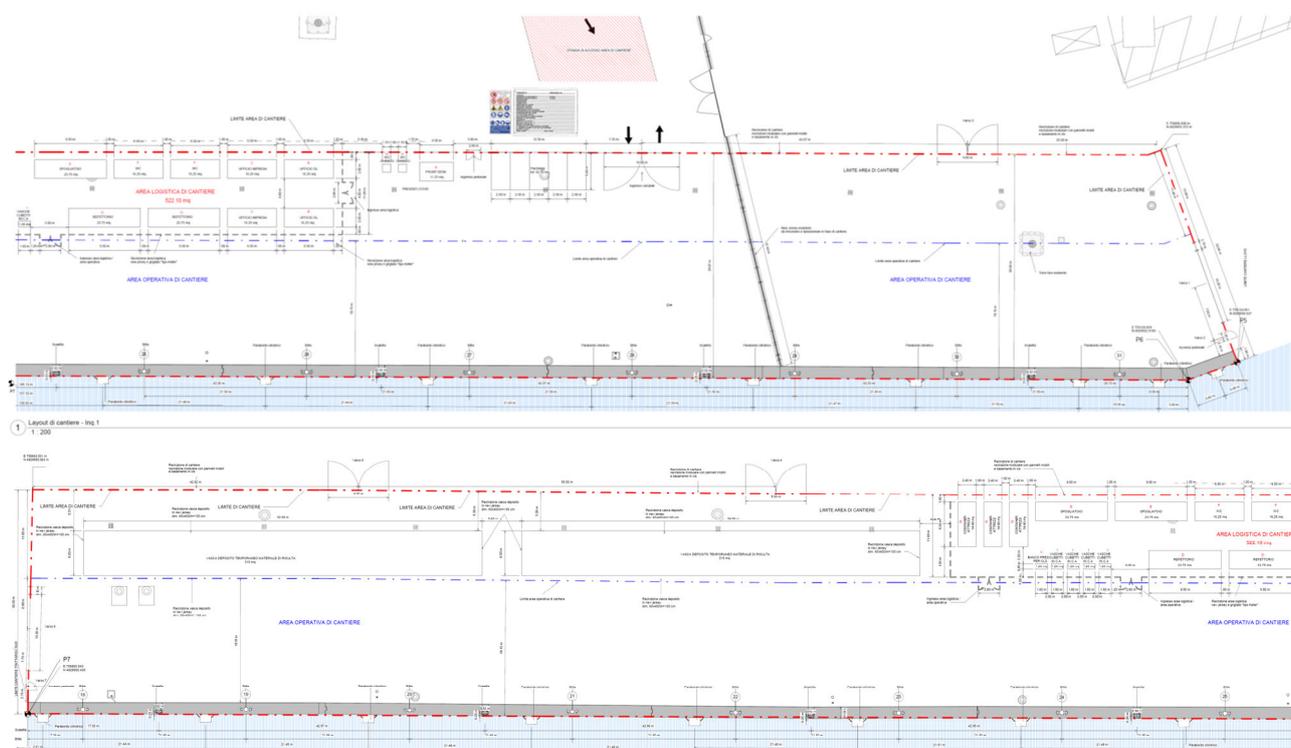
Banchina Trattaroli Nord – Layout generale di cantiere
